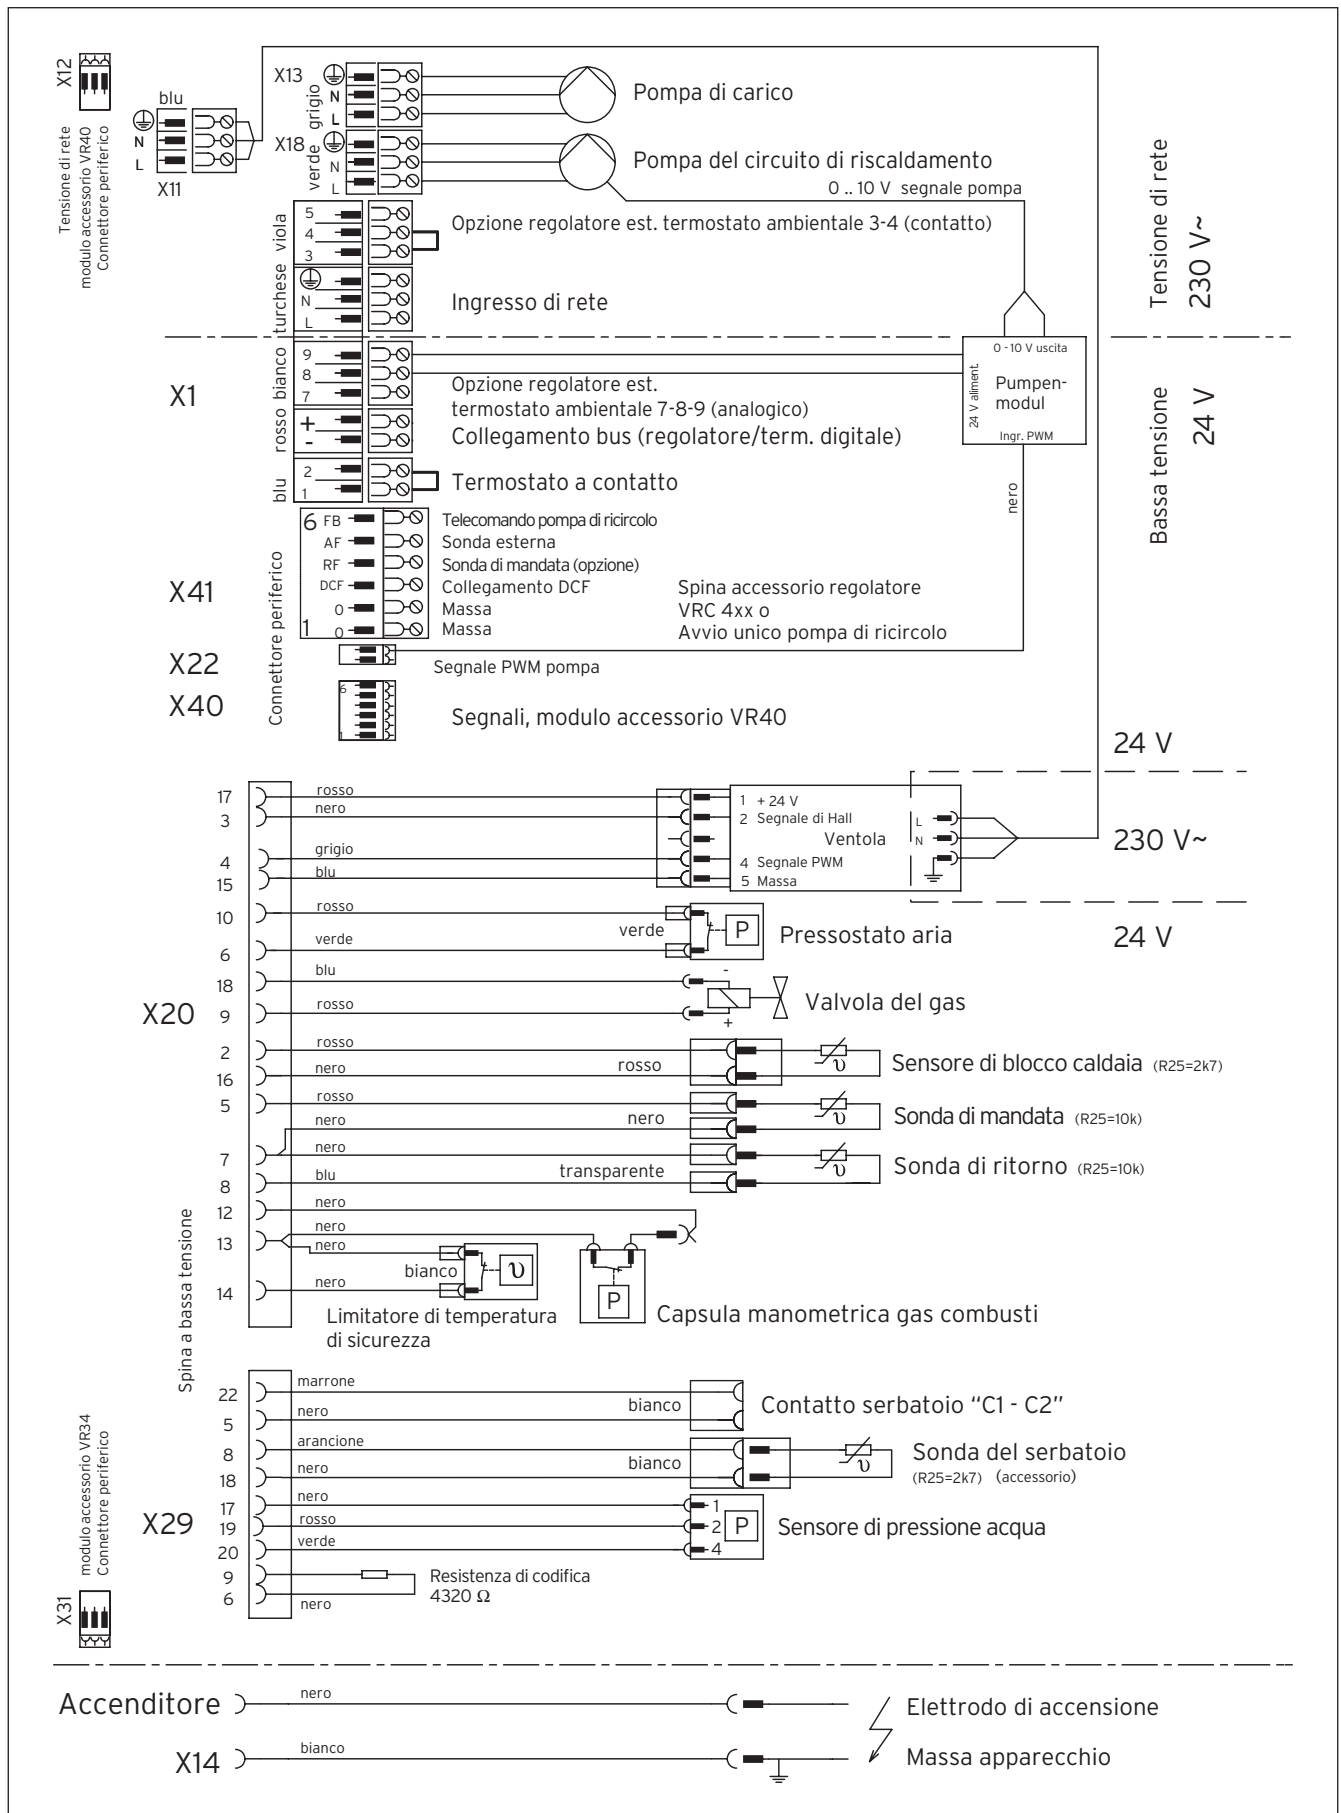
Collegamento di accessori elettrici e cablaggio interno
